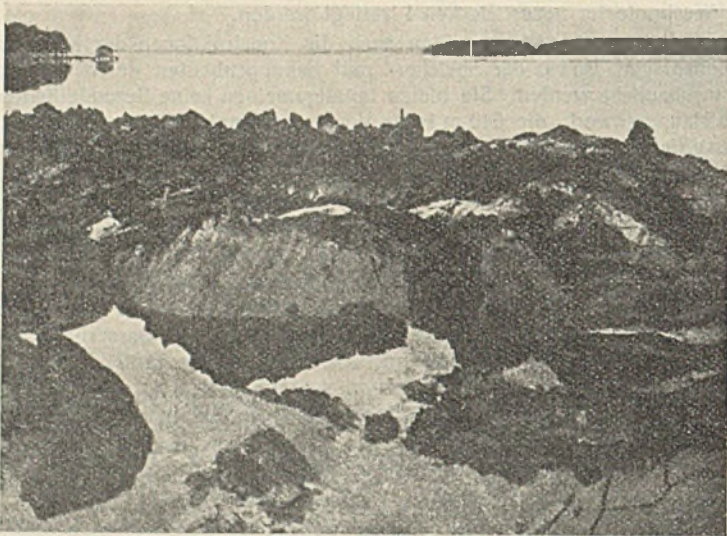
Erdrutsch bei Vita Sikudden mit dem hochgedrückten Untergrunde des Sees.
